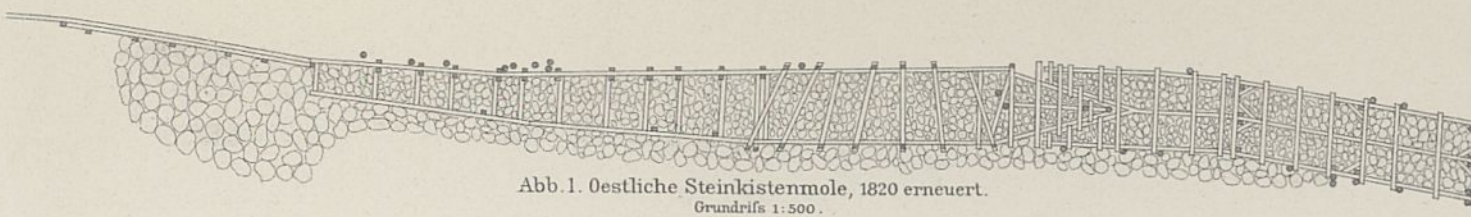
Oestliche Steinkistenmole, 1820 erneuert. Grundriss 1:500.
